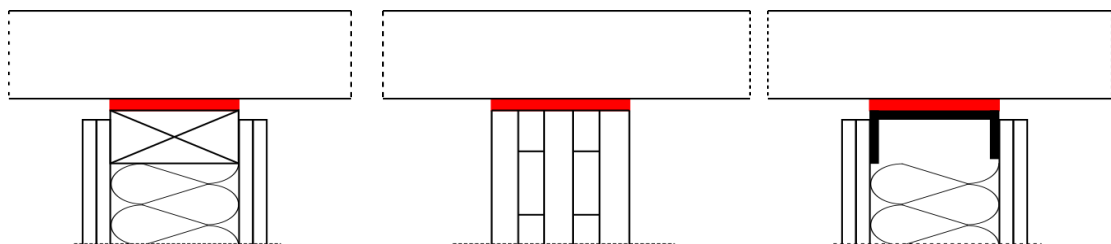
Vergleich Anschluss Wand an Decke unterschiedlicher Bauweisen (Holztafel, Massivholz, Trockenbau). Fügestelle (Kontaktfläche) als roter Balken dargestellt.
